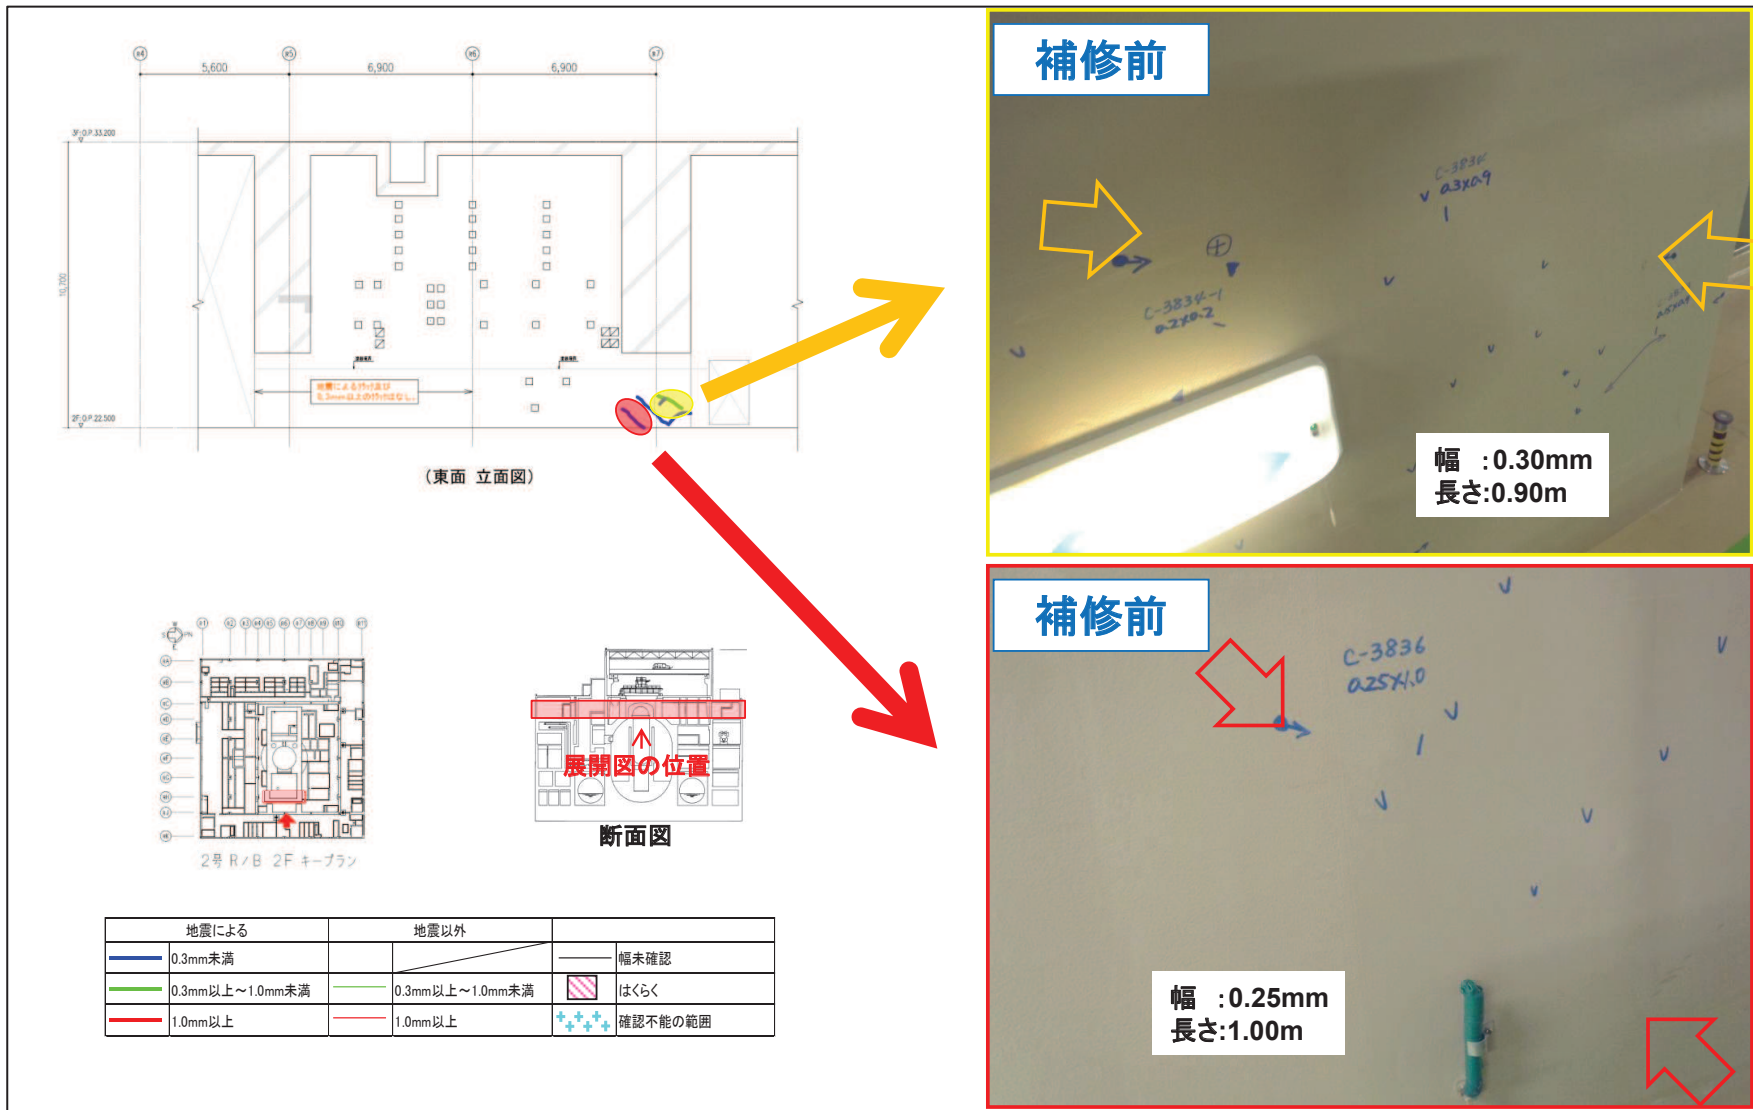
鉄筋コンクリート躯体のひび割れの例 (原子炉建屋地上 2 階)
